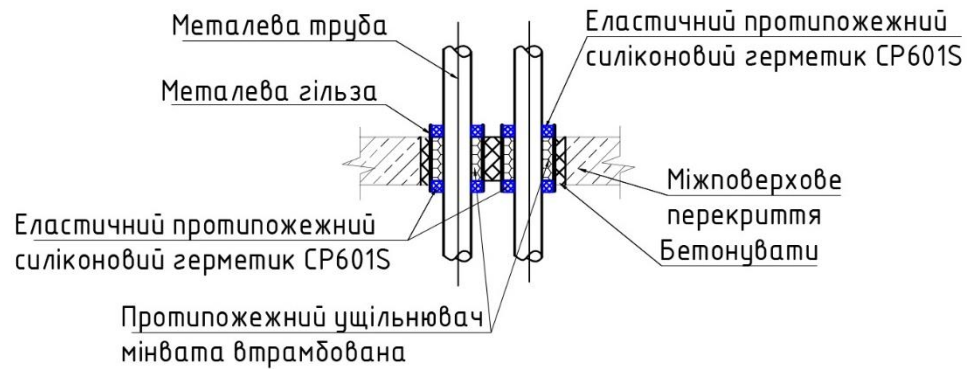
Схема вузла монтажної проходки трубопроводів крізь перекриття та стінові панелі
